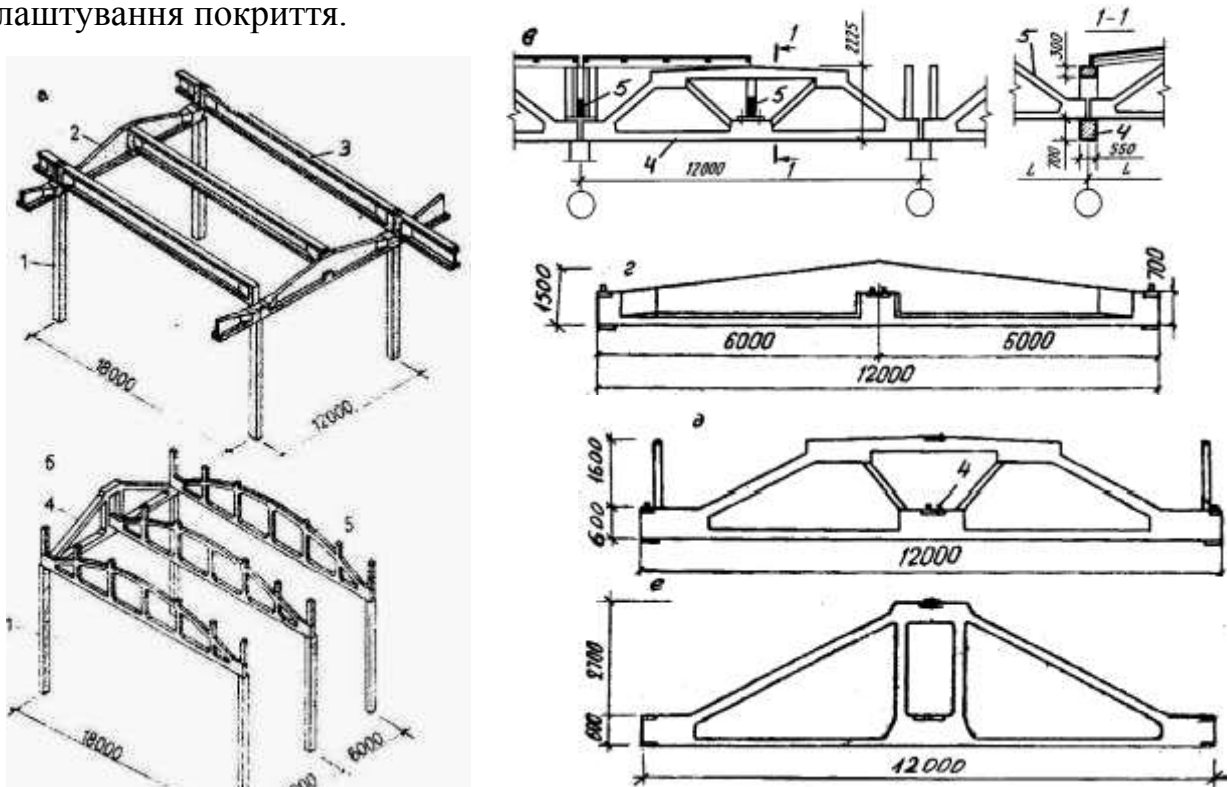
Залізобетонні підкроквяні балки і
